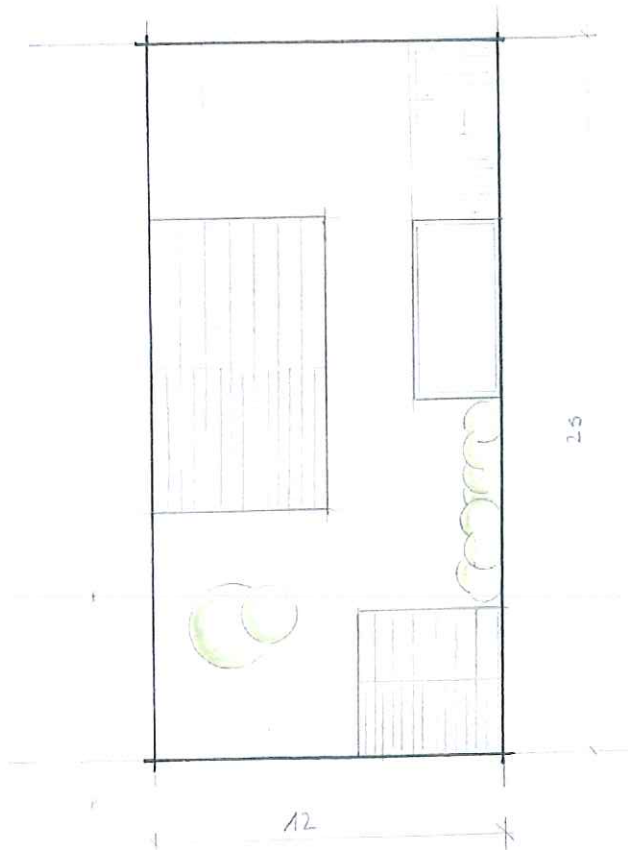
Haus 6 x 10 m mit Garage 3 x 6 m mit Zufahrt 3 x 5,5 m und Nebengebäude 4 x 4 m
